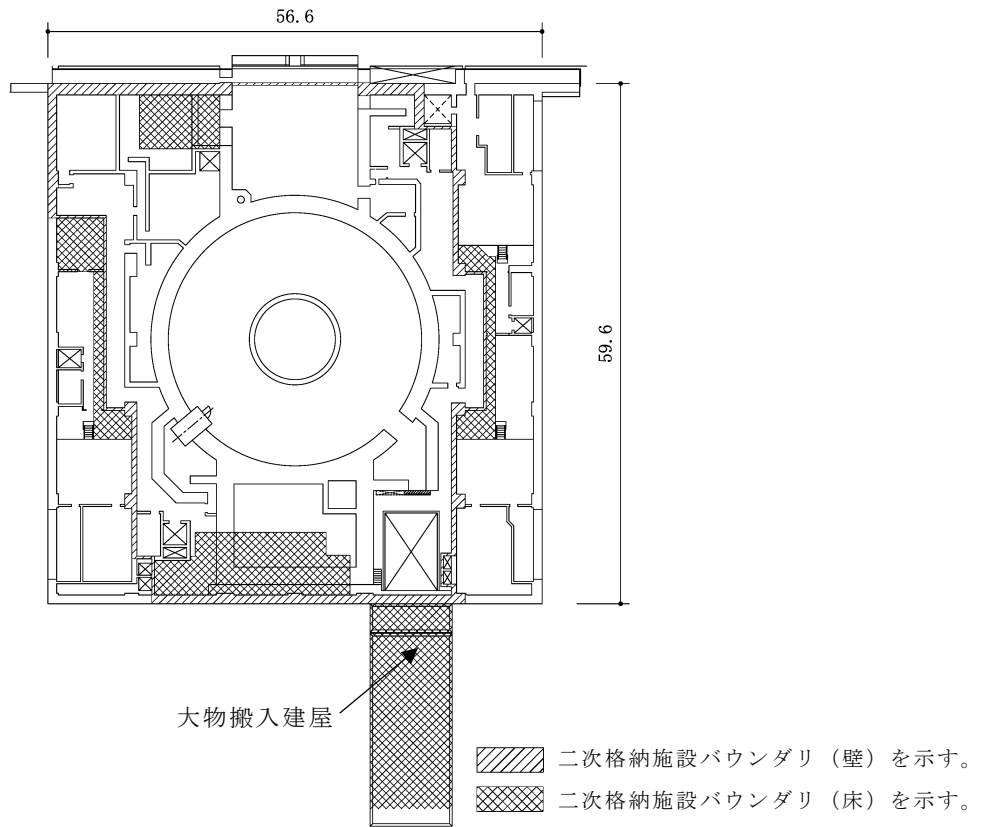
原子炉建屋原子炉区域（二次格納施設）の範囲の平面図
